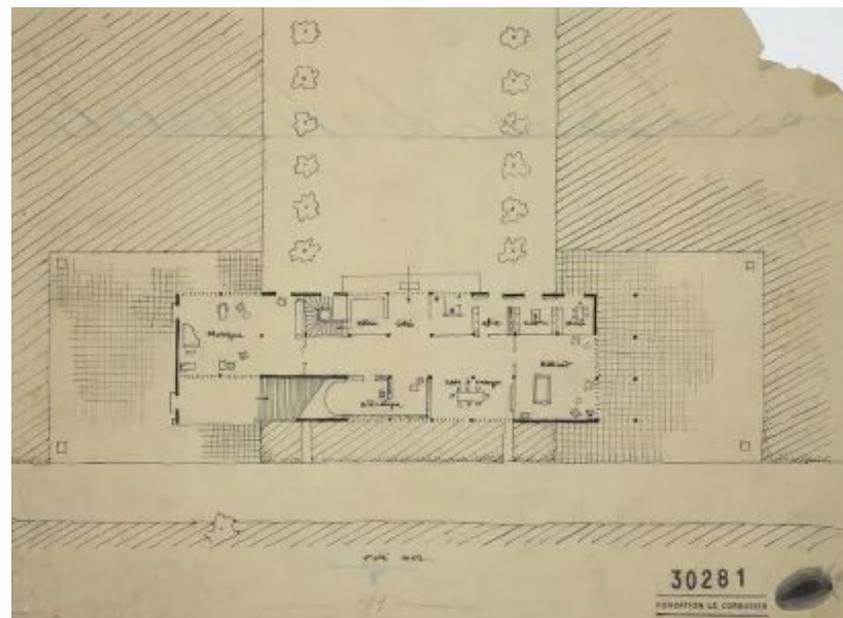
Imagen de la Fundación LC(30281). Villa au bor de la mer, planta baja.
